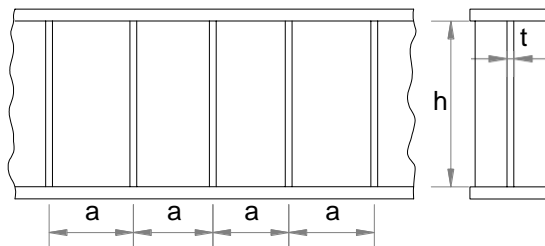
Trabe armada con el alma rigidizada por medio de atiesadores transversales.
